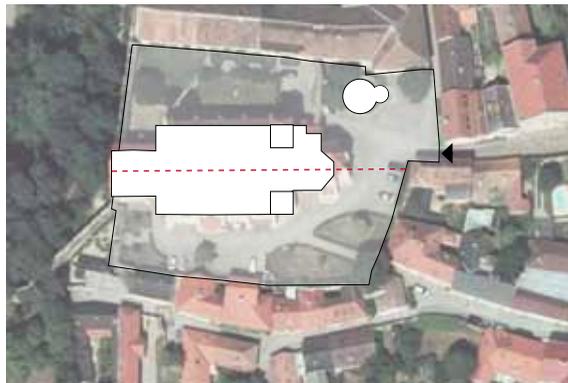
Grundriss MdkkCC 1886, 160.
